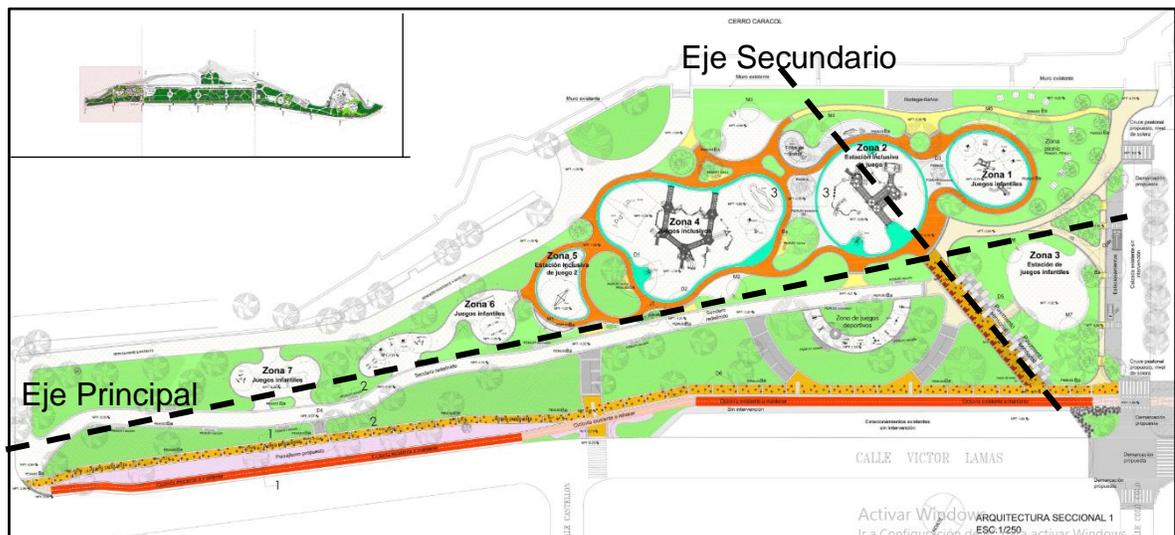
Planta del Área de juegos infantiles. Fuente: Arquitectos Concepción, 2014.
